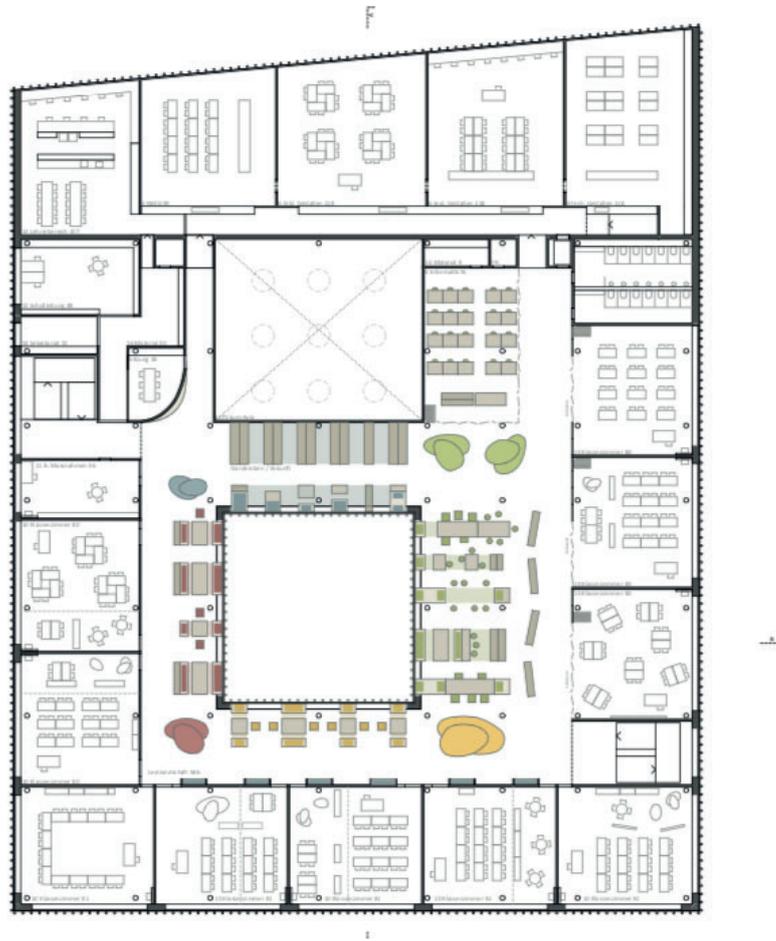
Grundrissplan Obergeschoss mit Lernlandschaft
